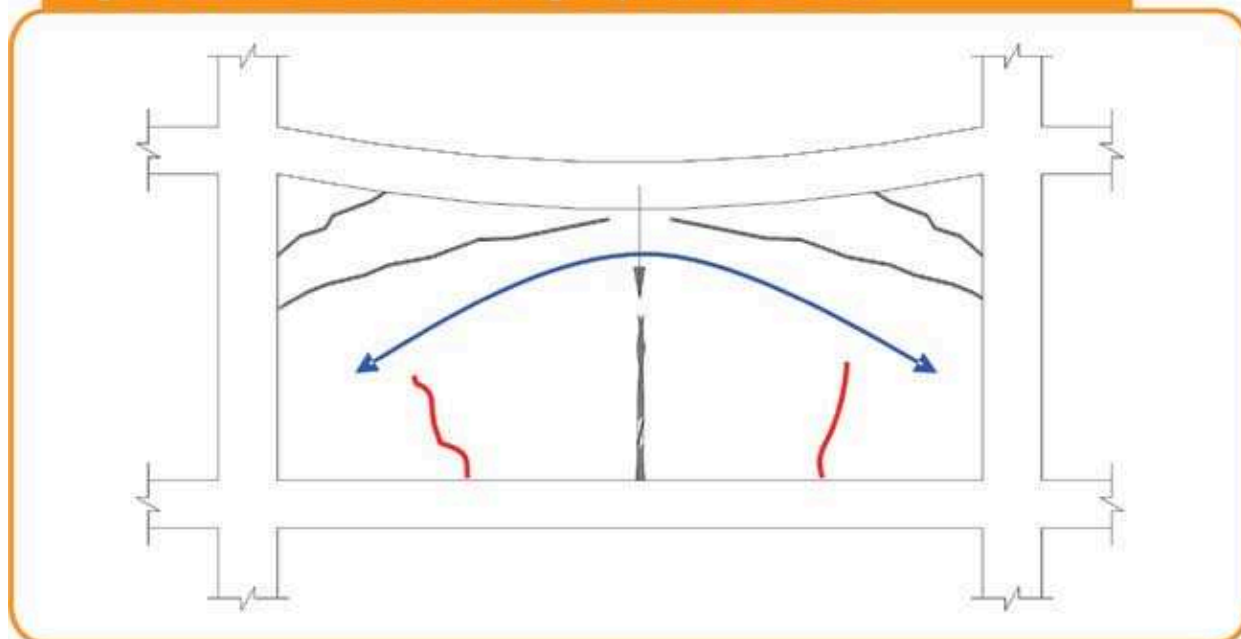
Exemplo de processo fissuratório em alvenaria
